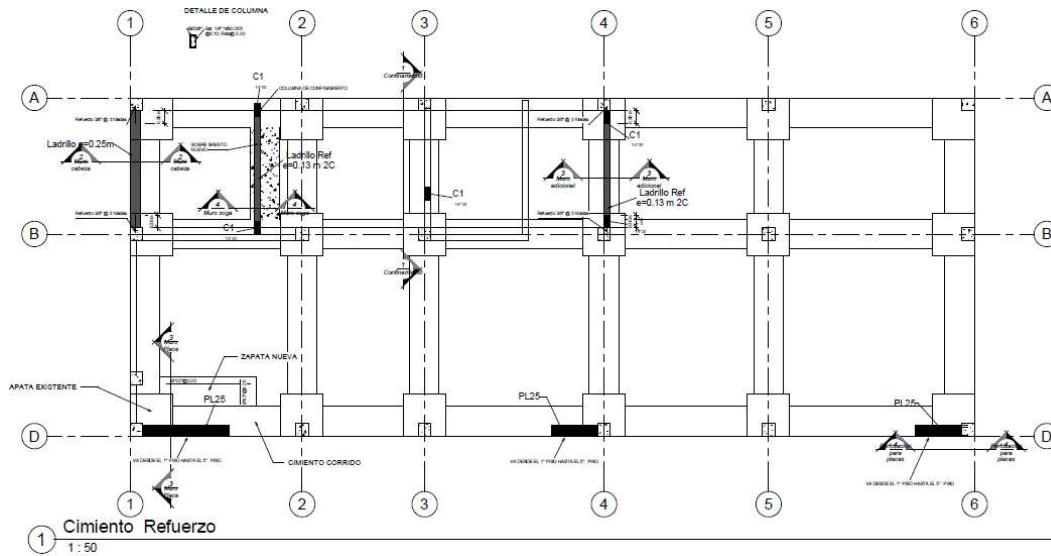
Cimentación Albañería Reforzada Fuente Propia
